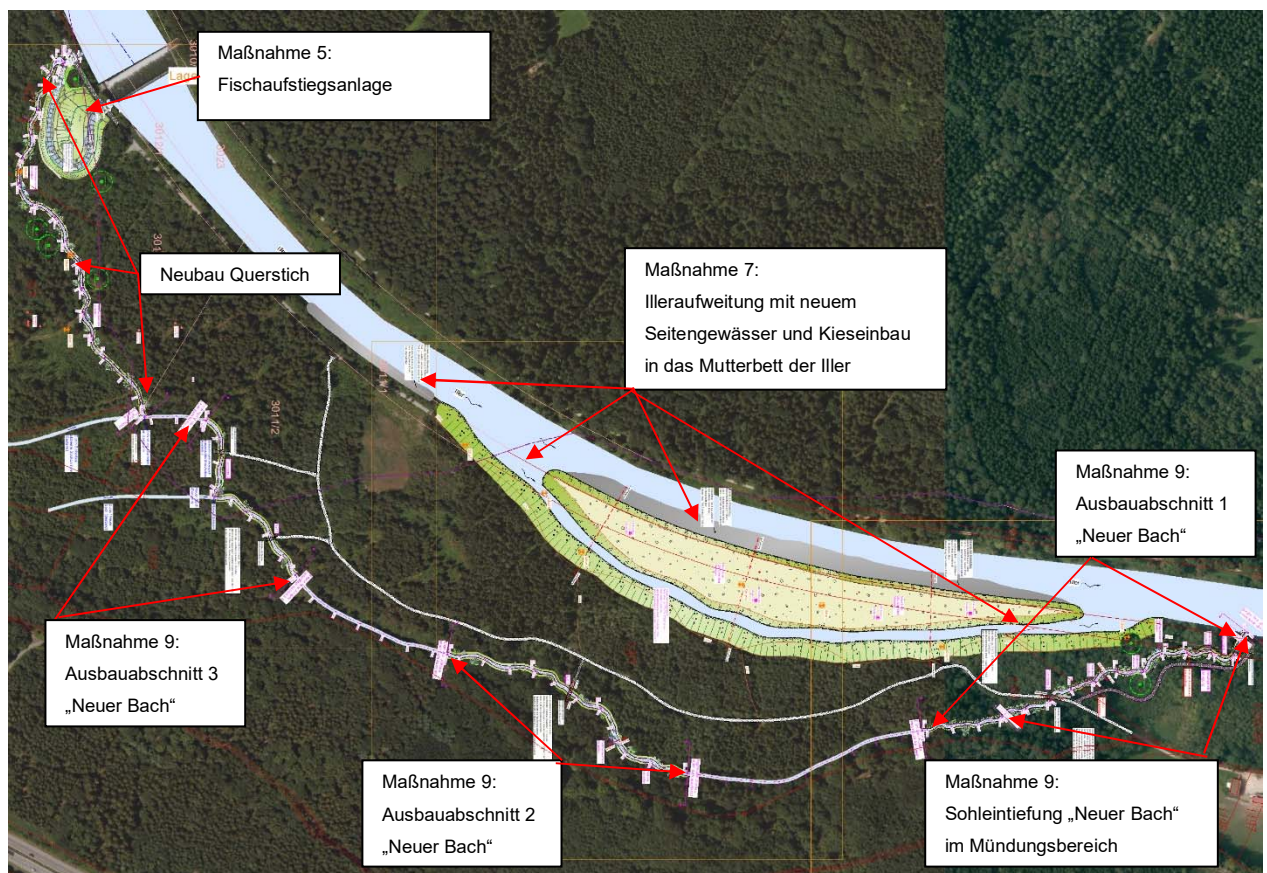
Übersichtslageplan mit Darstellung der Maßnahmenpunkte
